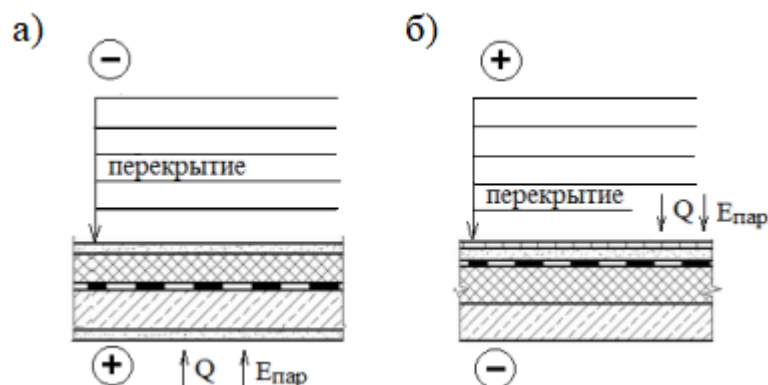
Конструктивные решения перекрытий: а) чердачное; б) надподвальное
